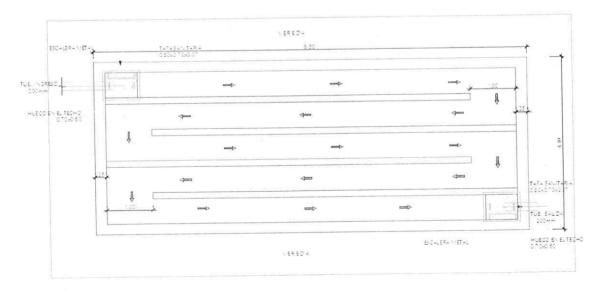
Vista en Planta de la Cámara de Contacto proyectada
